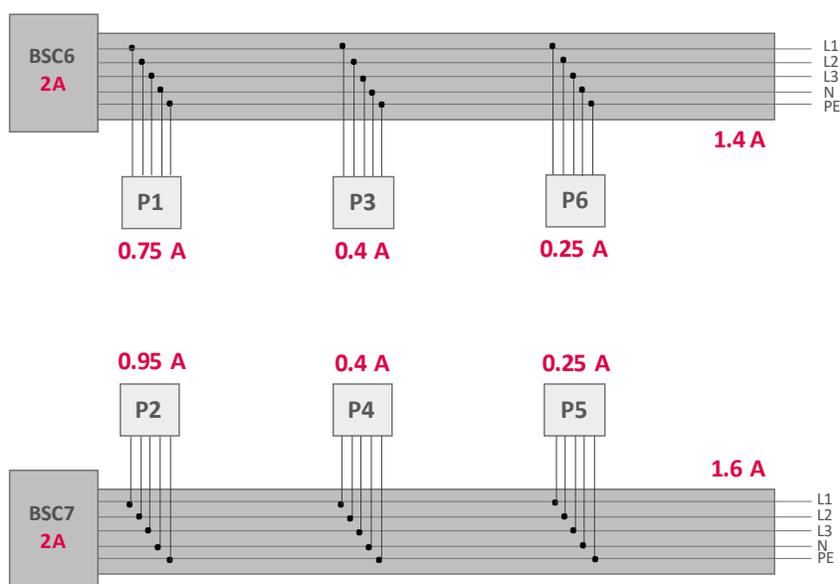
Configurazione dei collegamenti della Combiner I2 all'impianto elettrico con utilizzo della Machine Installation_Checklist
